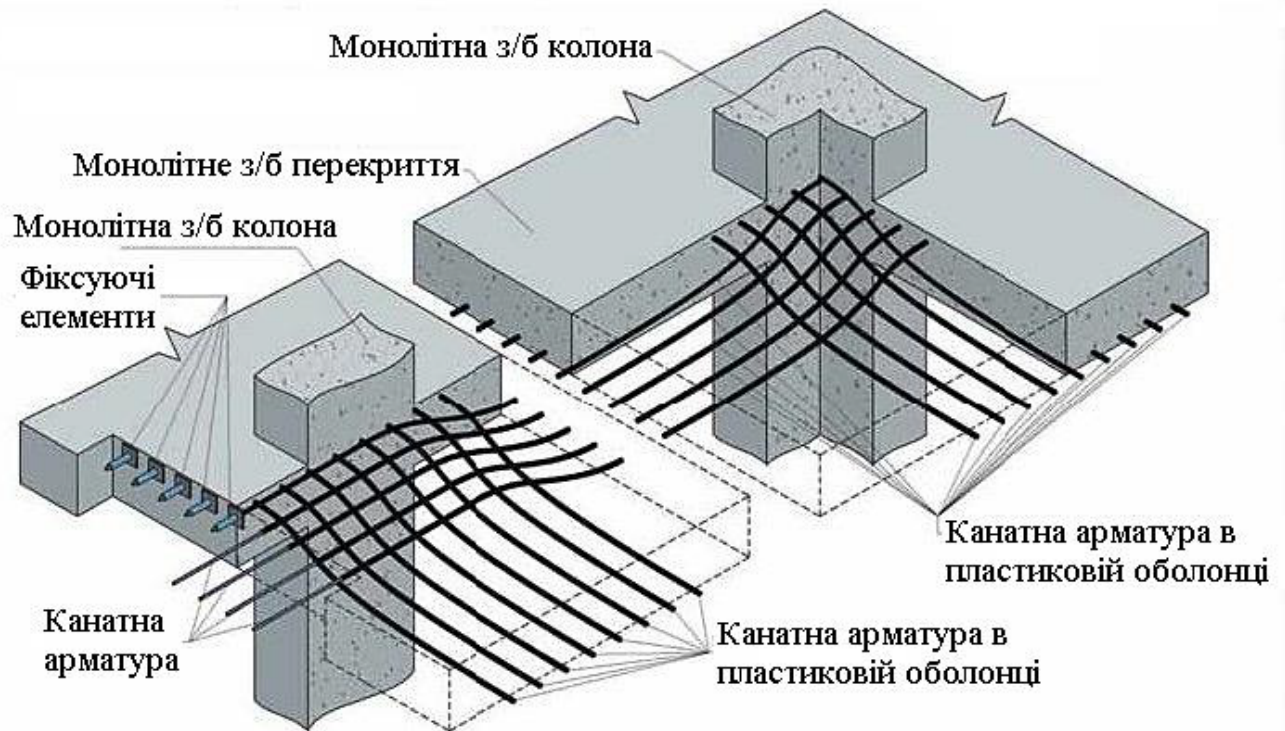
Фрагмент армування плити перекриття попереднього напруження канатною арматурою.
